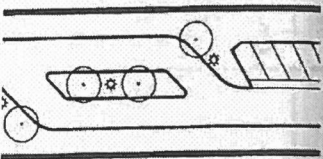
Abmessungen von und Flächenbedarf für Pkw im Straßenraum
